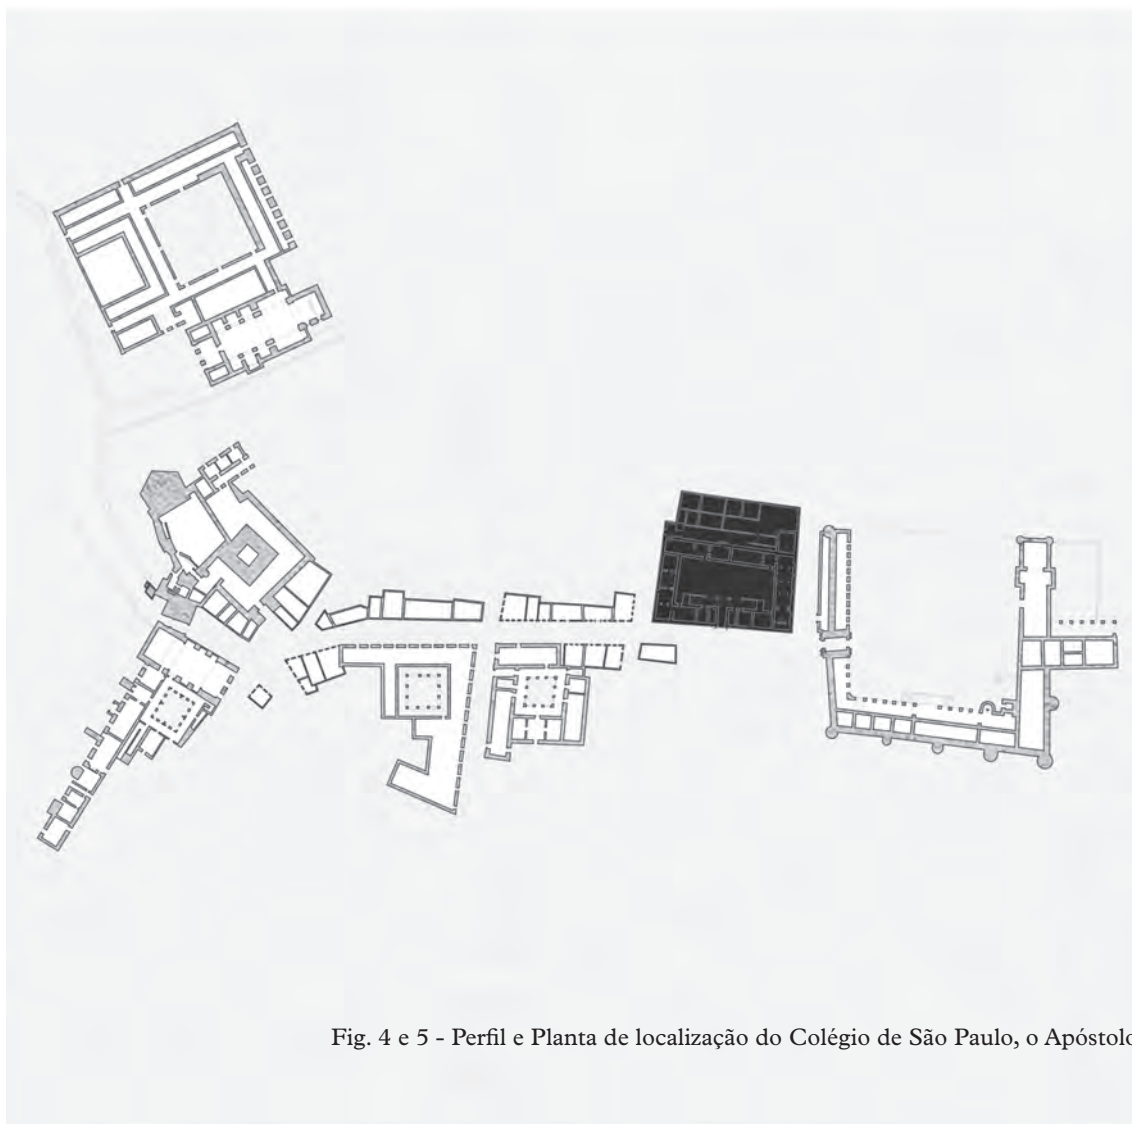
e 5 - Perfil e Planta de localização do Colégio de São Paulo, o Apóstolo
